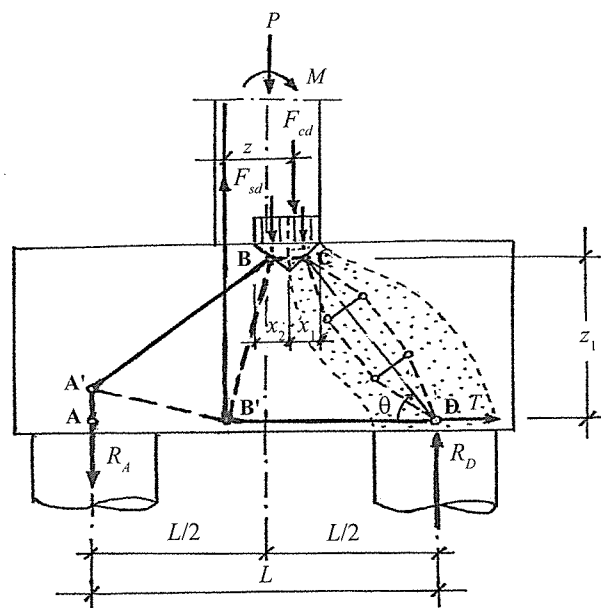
Modélisation B-T pour une semelle rigide sur deux pieux sous poteau en flexion composée de section partiellement comprimée avec aciers tendus, et $R_A < 0$.
